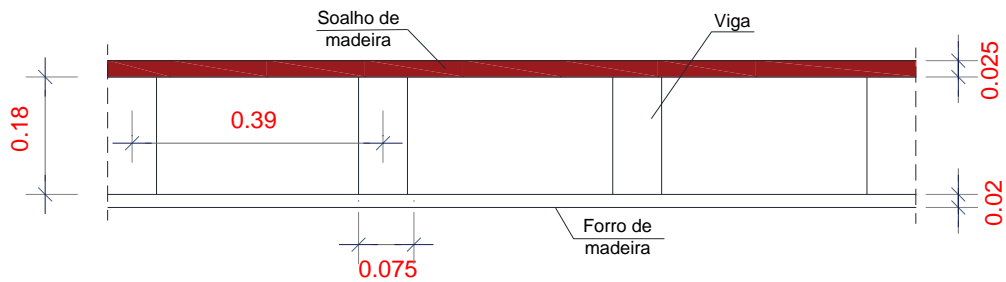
Detalhe das dimensões das vigas do pavimento do piso 2 (corte representativo)
